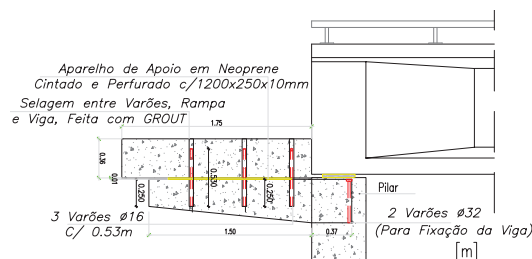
Pormenor de fixação entre a rampa e a viga alçado (lateral) [62]
